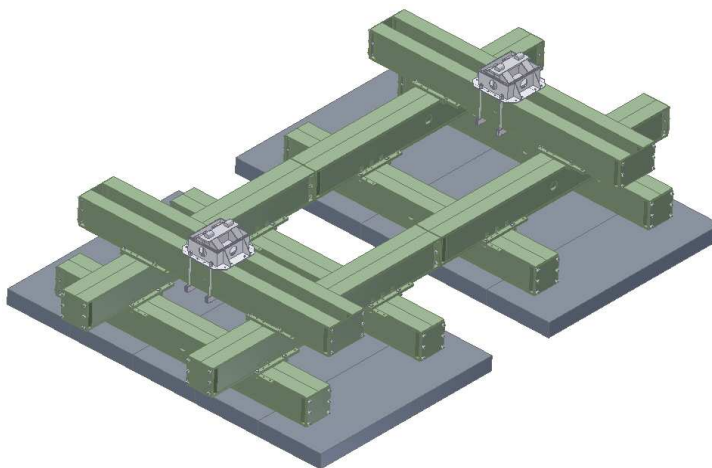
Možné způsoby založení pilíře PIŽMO
